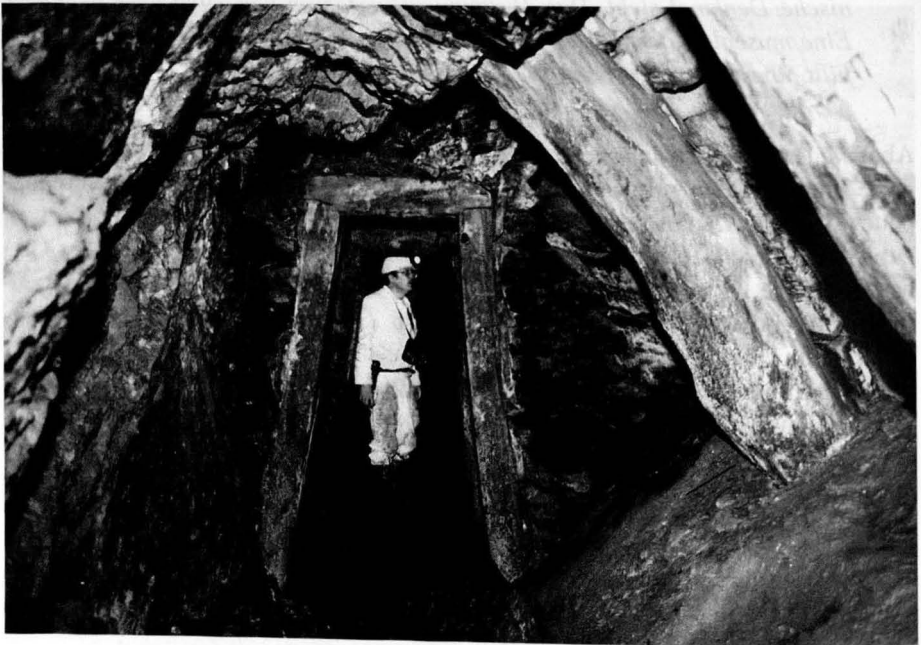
Grubenausbau in Holz und Trockenmauerwerk, Grube Glasebach, 5. Sohle, heute unzugänglich. Rechts vorne Ausbau mit mächtigen Eichenstämmen und gerissenen Bohlen, vermutlich 17. Jahrhundert, im Zentrum Türrstockausbau aus Eiche, Ende 18. bis Anfang 19. Jahrhundert.
